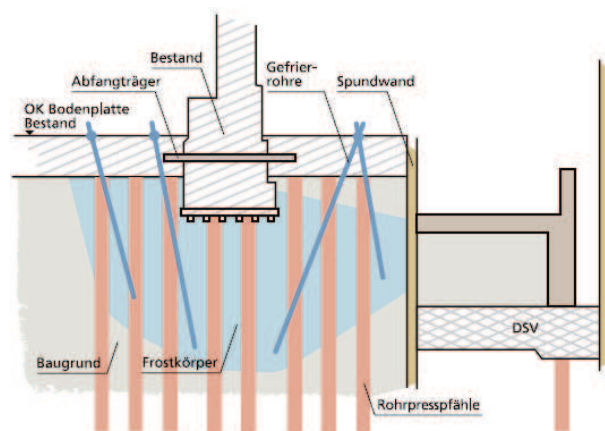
Gefrierinstallation zur südlichen Fassade Neues Museum Berlin
